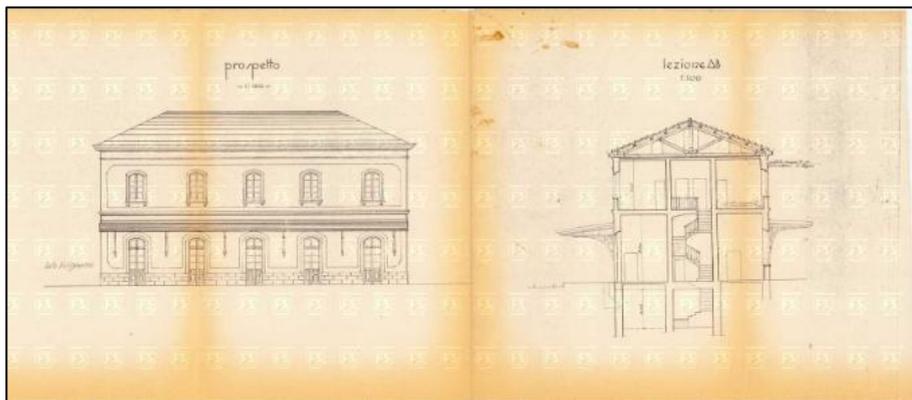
Stazione Ferrovie dello Stato di Lagonegro. Particolare del prospetto e della sezione. (Fonte: Archivio Architettura della Fondazione FS, 1964.)
